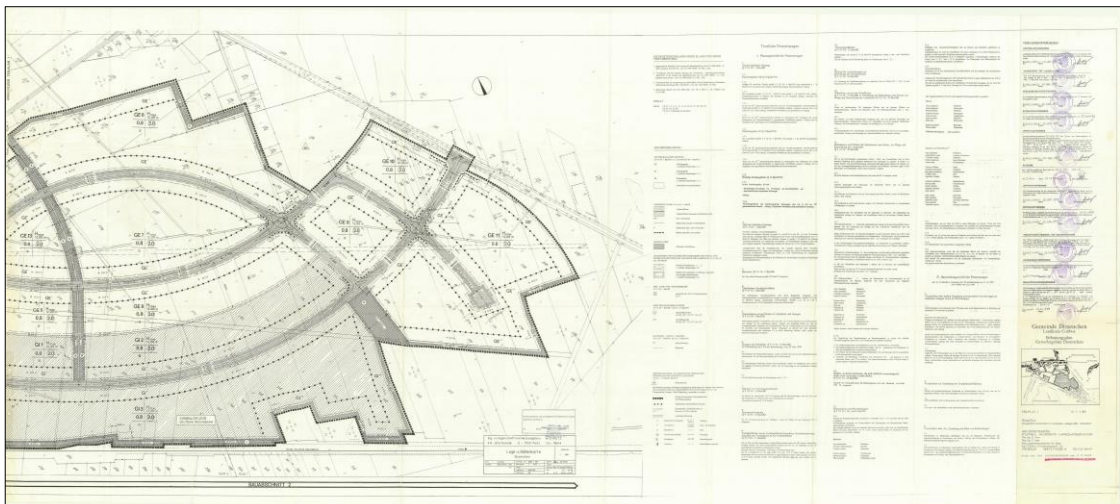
Bebauungsplan Gewerbegebiet Dissenchen Süd II, Urkunde, Teilplan 2
